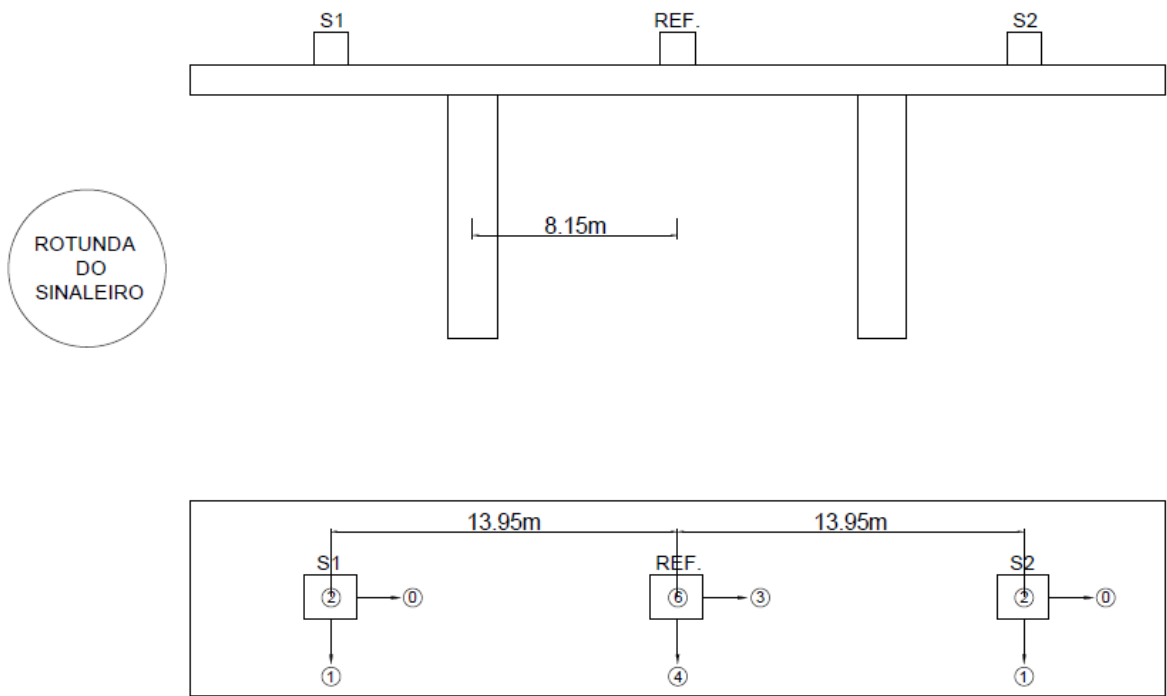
Esboço geral do esquema de setups no ensaio do Ponte Afonso Zuquete.
